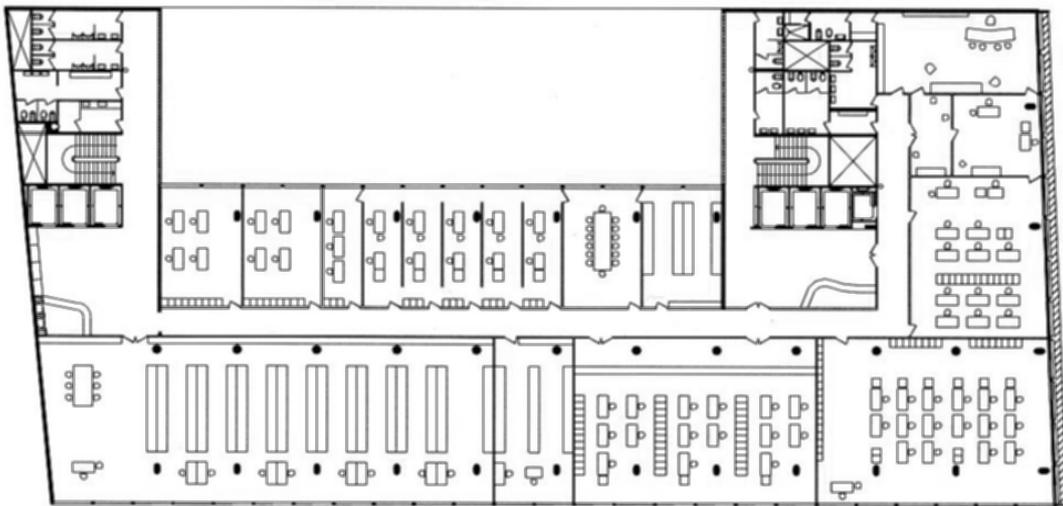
Planta dos nove pavimentos-tipo: planta livre em forma de U achatado.
